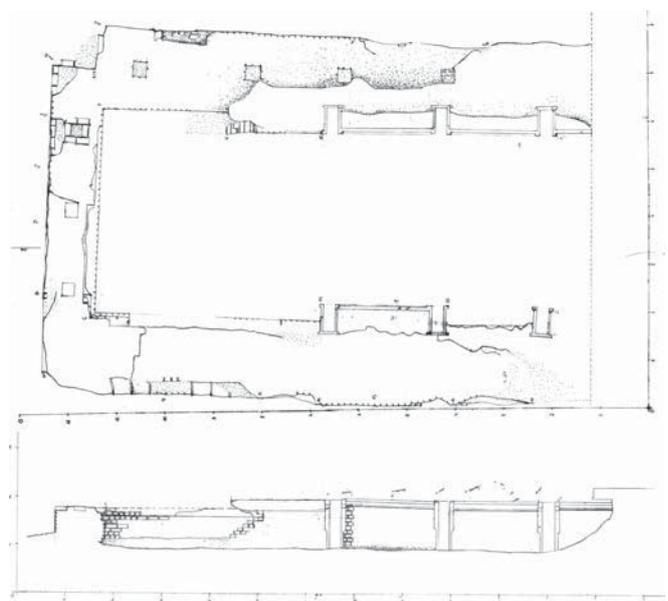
Arbeitsprobe eines Teams als Grundriss und Schnitt.
